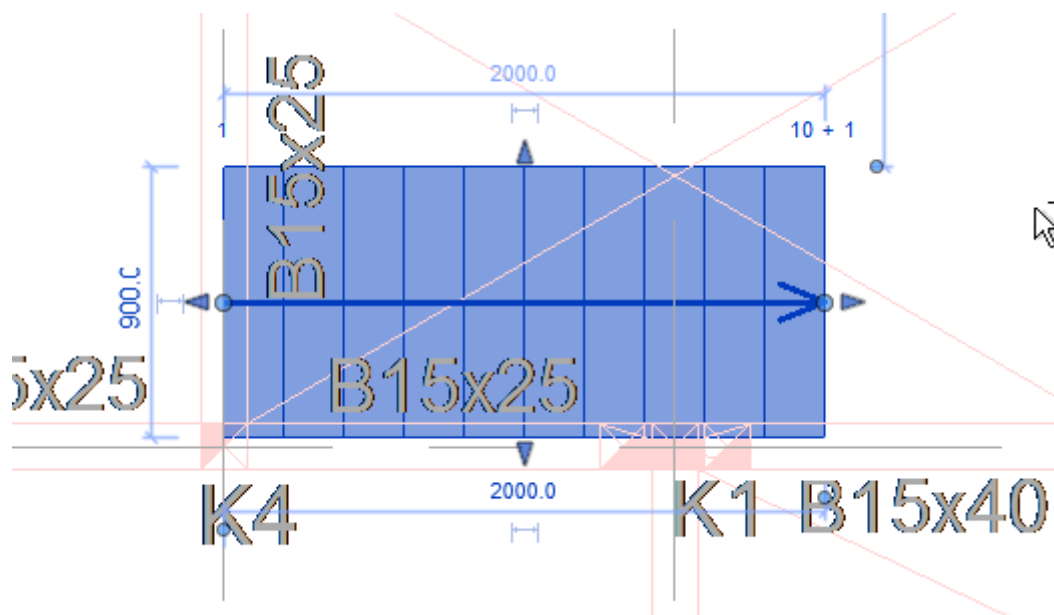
Pemilihan Tipe Tangga Straight pada Tab “Structure”
